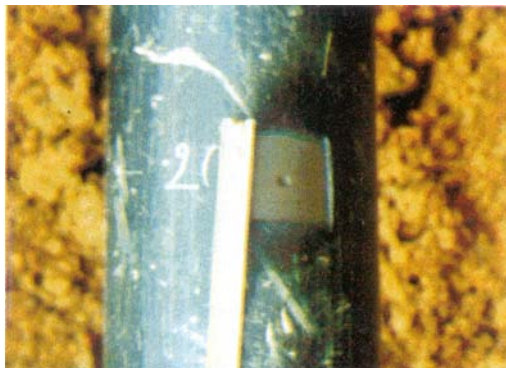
Corrosion (diam 5 mm; prof. 0,5 mm)
